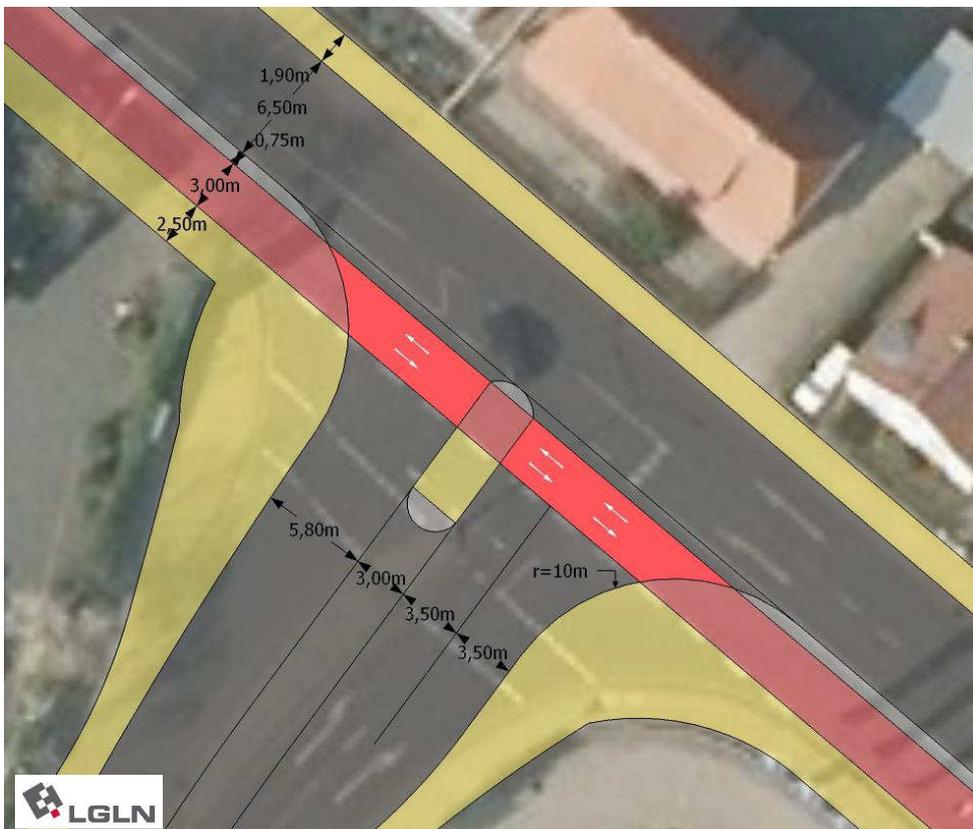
Skizze Knotenpunkt Emmerstedter Straße / Industriestraße Variante B: Einmündung mit Radfurt für den durchgehenden Zweirichtungsradweg
